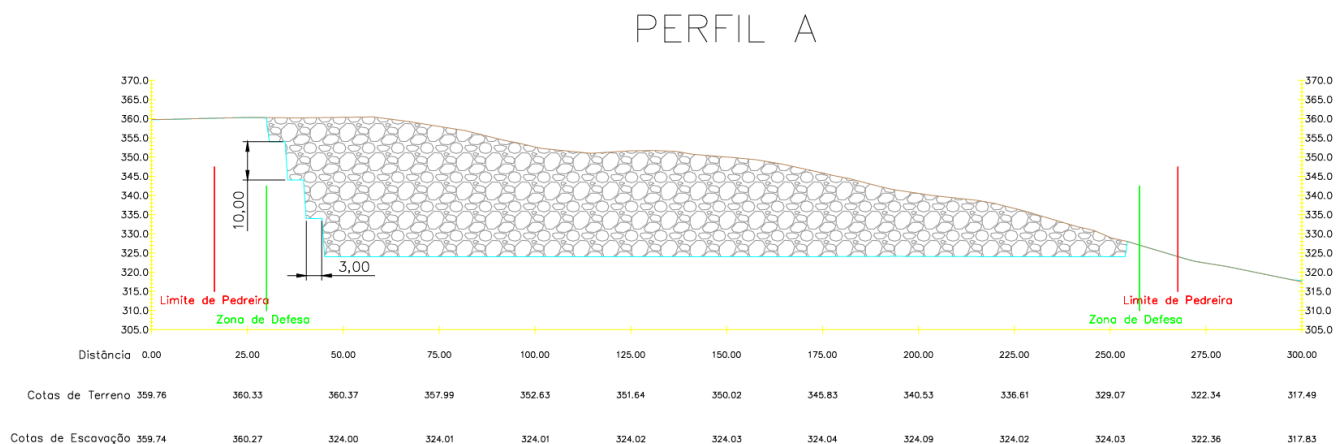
Configuração das bancadas. Fonte: Plano de Pedreira
